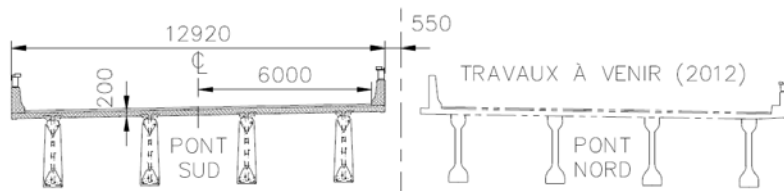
Coupe du pont sud et du pont nord sur les poutres en béton précontraint
